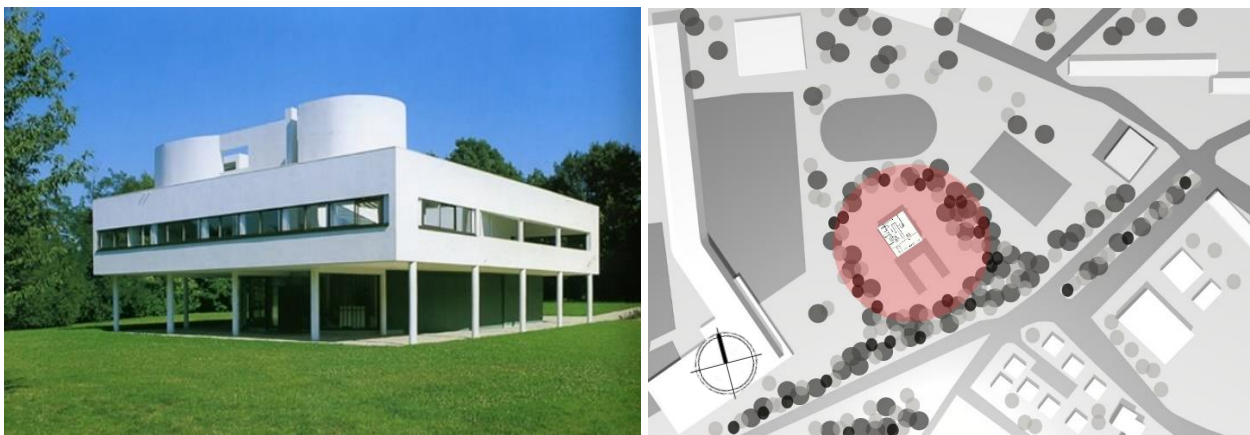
Villa Savoye, Fotografía Flavio Bragaia. Planta de implantación Ville Savoye, Autoría propia.
